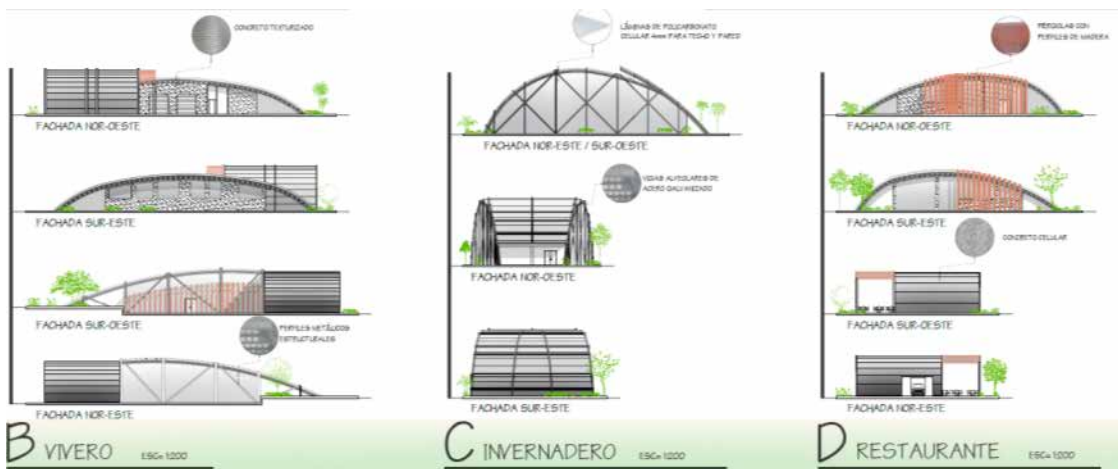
Fachadas del conjunto con especificación de materiales. Fuente: Propia
